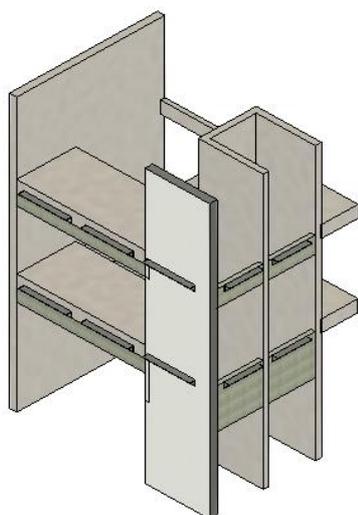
Betonagem dos maciços e inserção das cantoneiras até ao segundo piso
